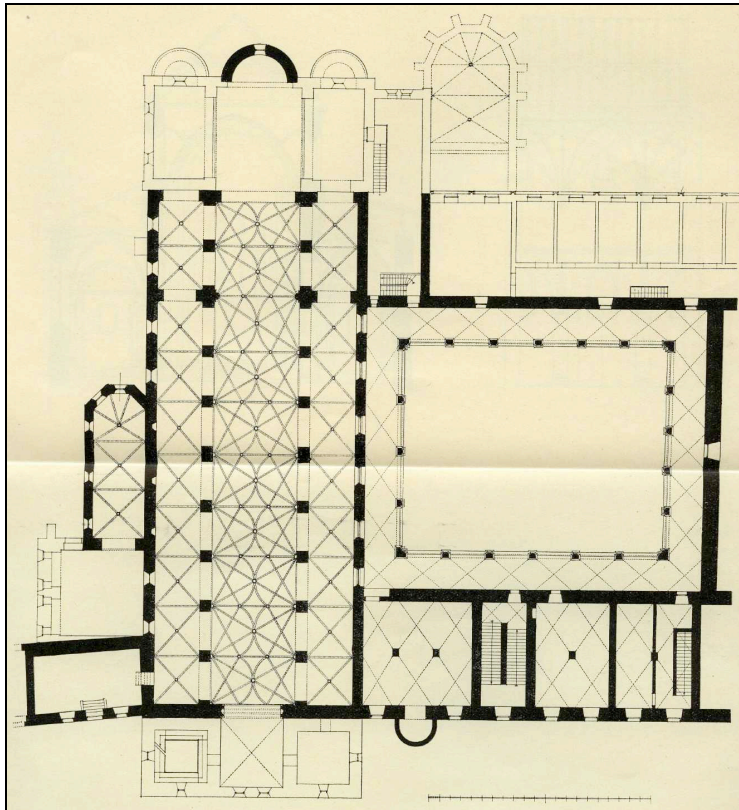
Seckau, Klosterkirche mit Kreuzgang, Grundriss um 1960, 1: 22.
